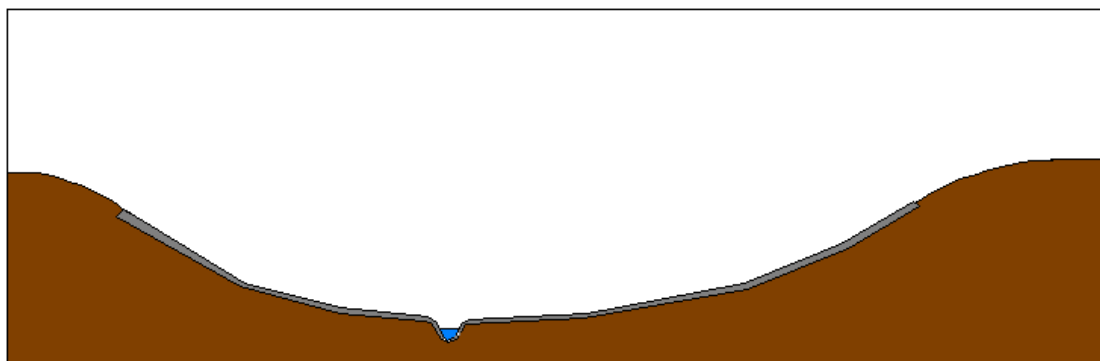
Ejemplos de la sección transversal de un vado hormigonado.
